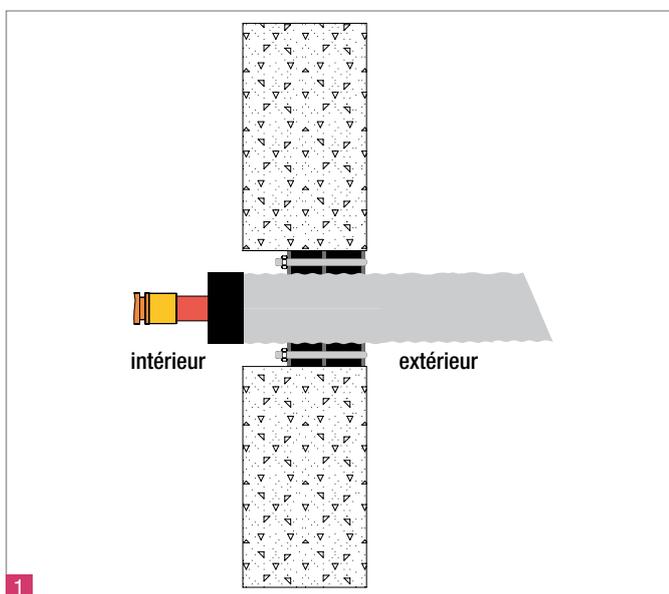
, Bride murale étanche FA 80 simple, vue latérale
